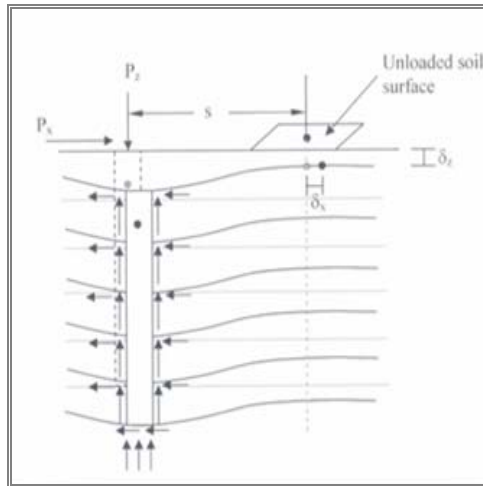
Interacción entre pilote cargado y terreno descargado – Interacción Pilote-Terreno (Chow, 2007)
